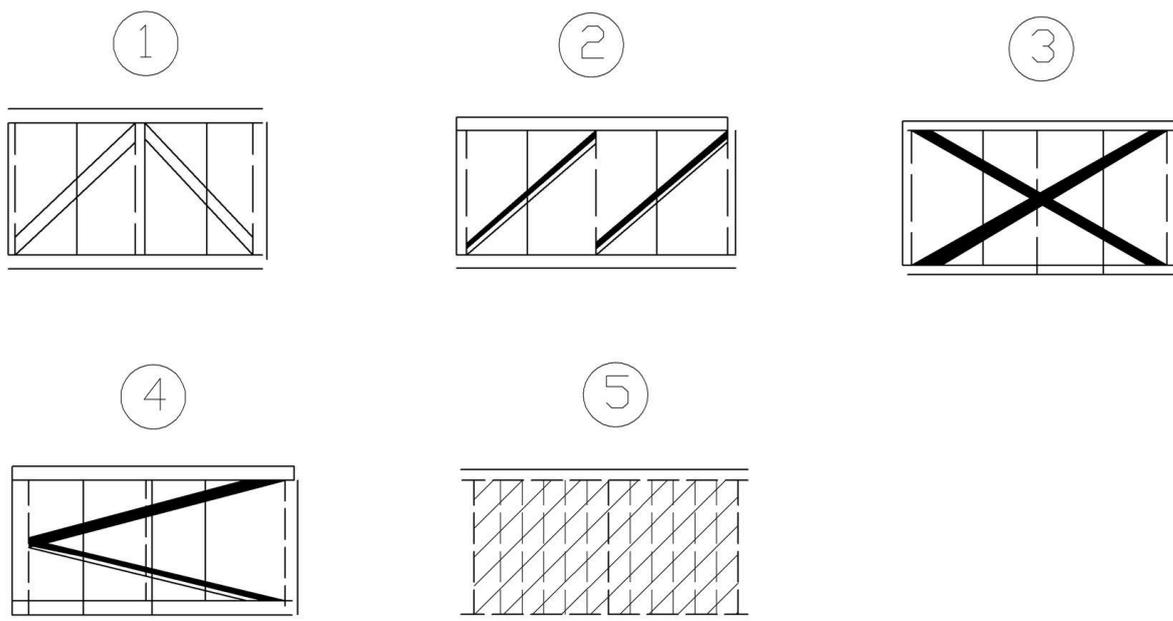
Схемы связей. 1 – 3 при шире конструкций до 4,5 м, 3-5 – при шаге конструкций 6 м: 1 – треугольные ; 2 – подкосные; 3 – крестовые; 4- порталного типа; 5 – перекрестный настил из досок.
